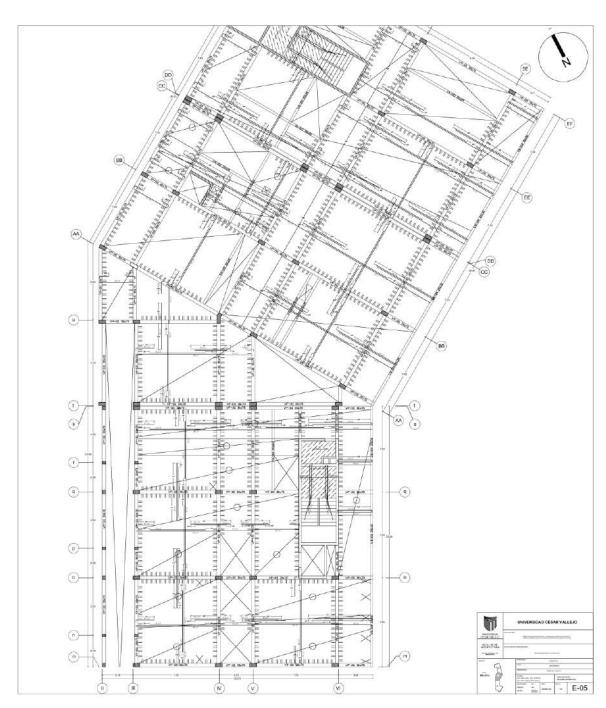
Aligerado - Primer piso sector C - ESTRUCTURAS
